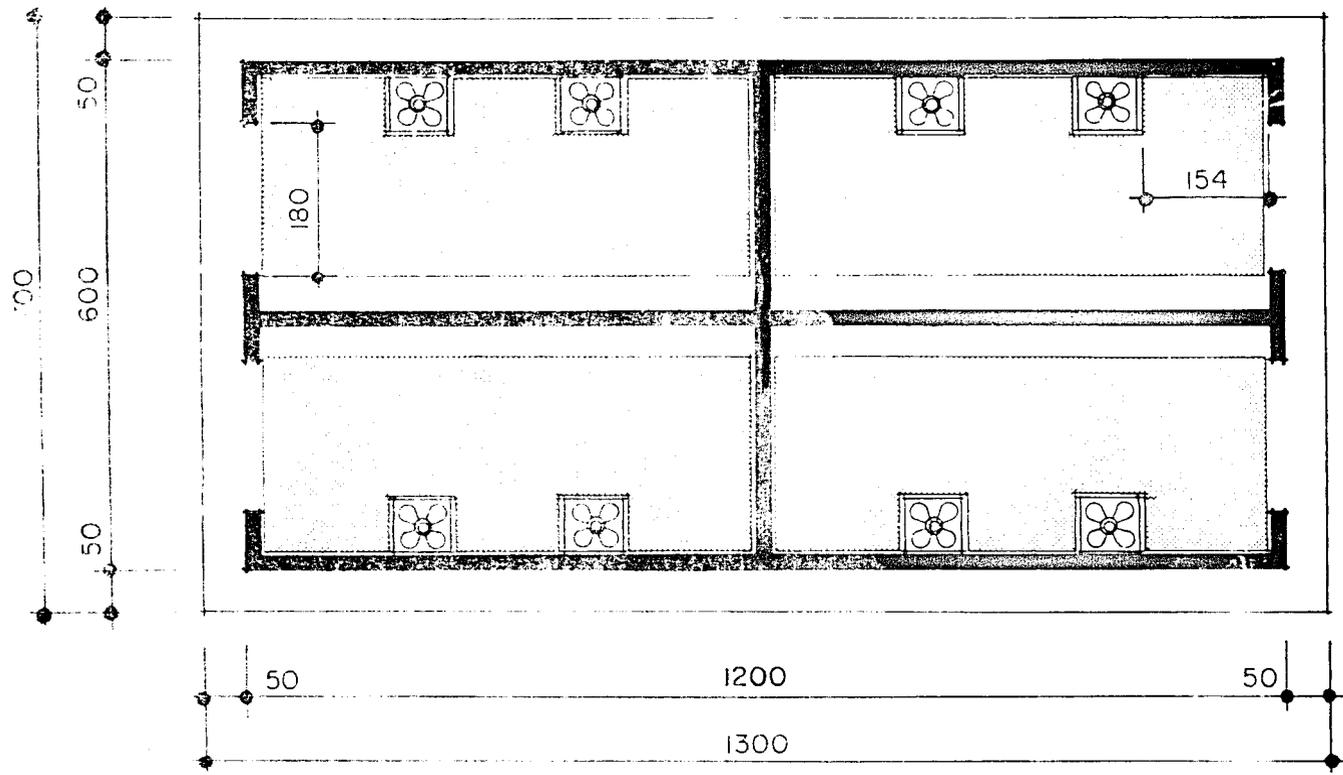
PLANTA SECADOR 10,000 pies tablares
